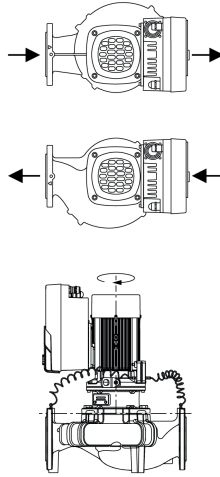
Dikey motor mili ile izin verilen montaj konumları
